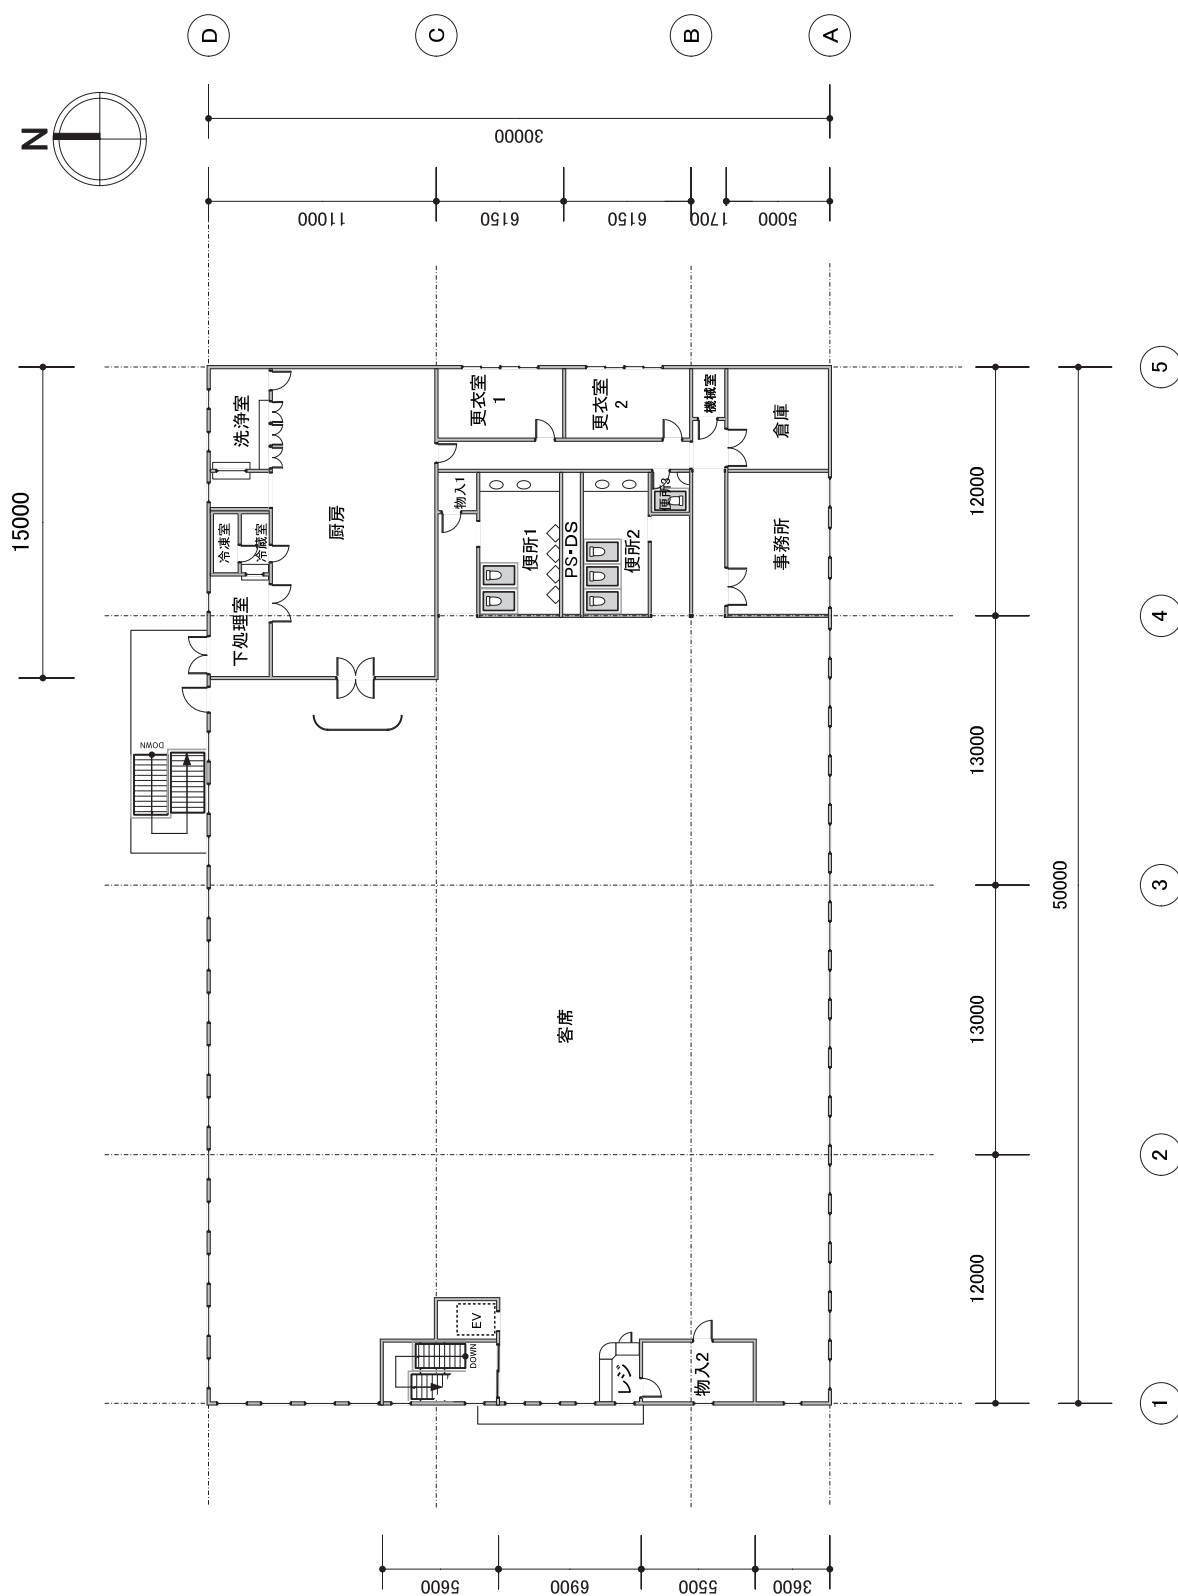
A.30 モデル建物（飲食店等、3,000 m<sup>2</sup>）2 階平面図
